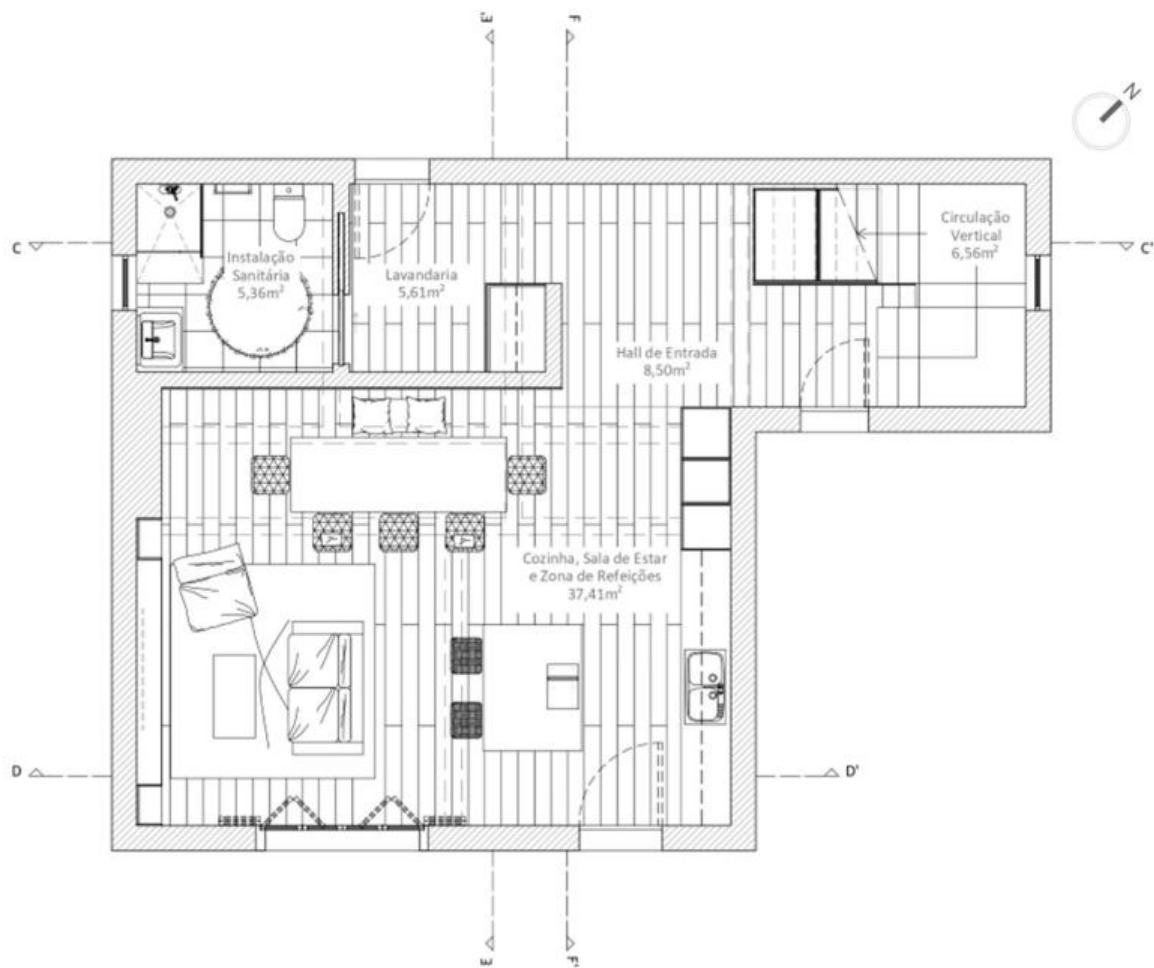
Planta de Apresentação do Piso 0. Fonte: Autor
